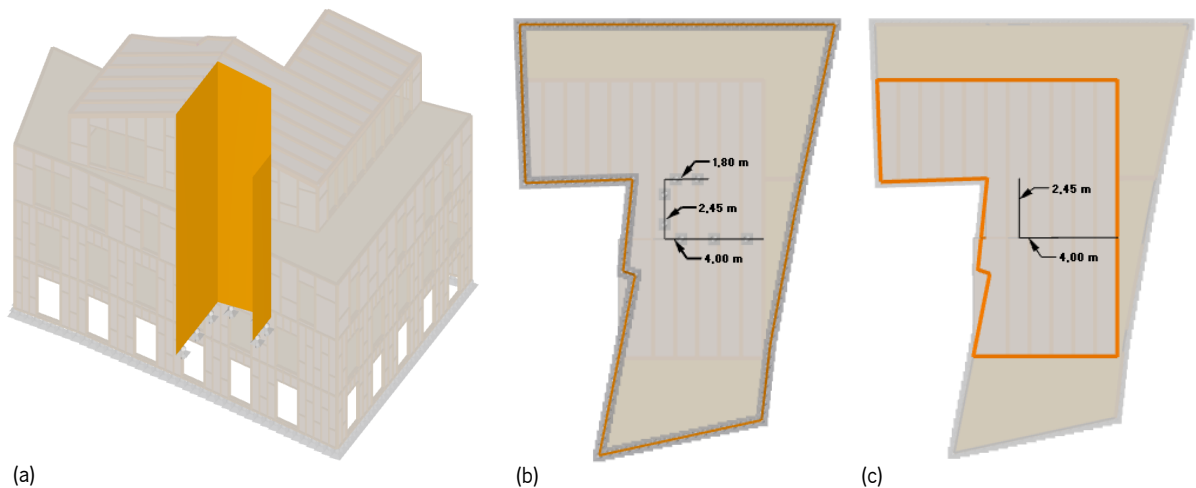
Núcleo do edifício: Caixa de escadas. (a) 3D; (b) Localização em planta nos pisos 1, 2 e 3; (c) Localização em planta no piso 4
